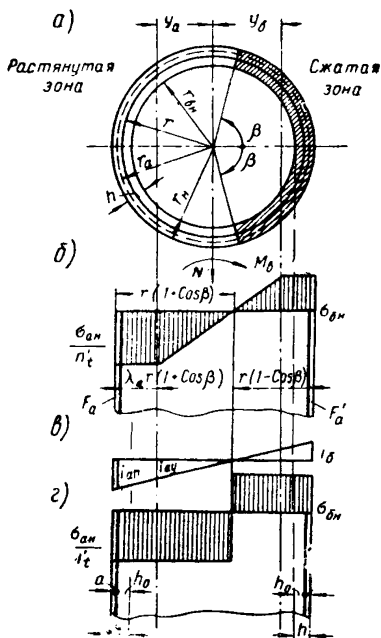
Расчетная схема горизонтального сечения трубы с ненапрягаемой арматурой
